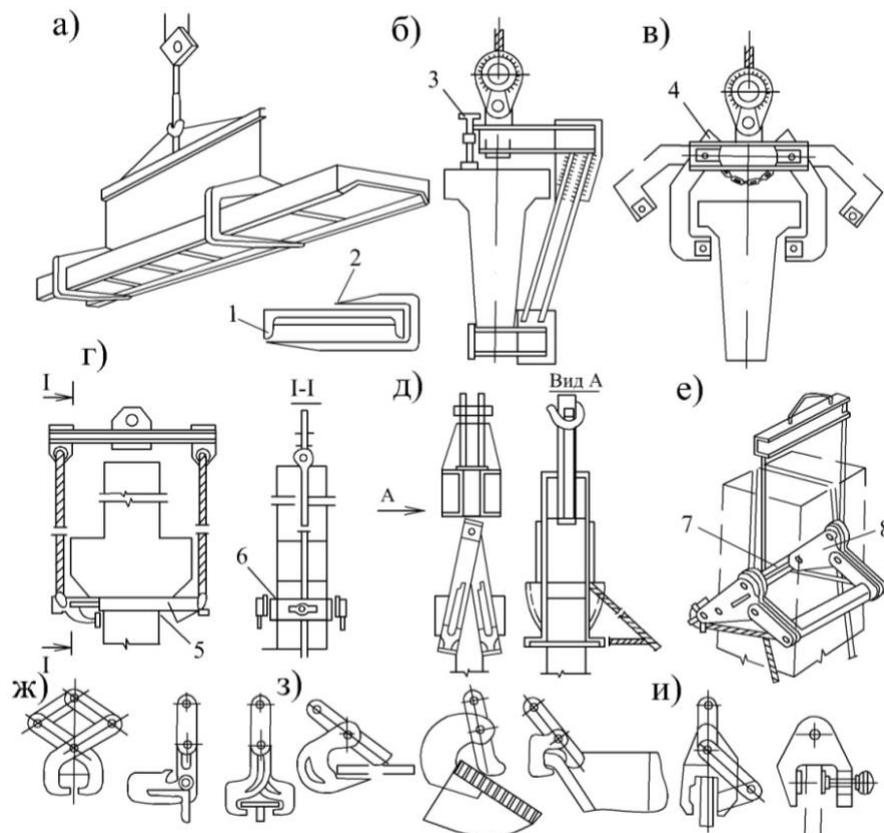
Схемы подъёма конструкций механическими захватными устройствами:
